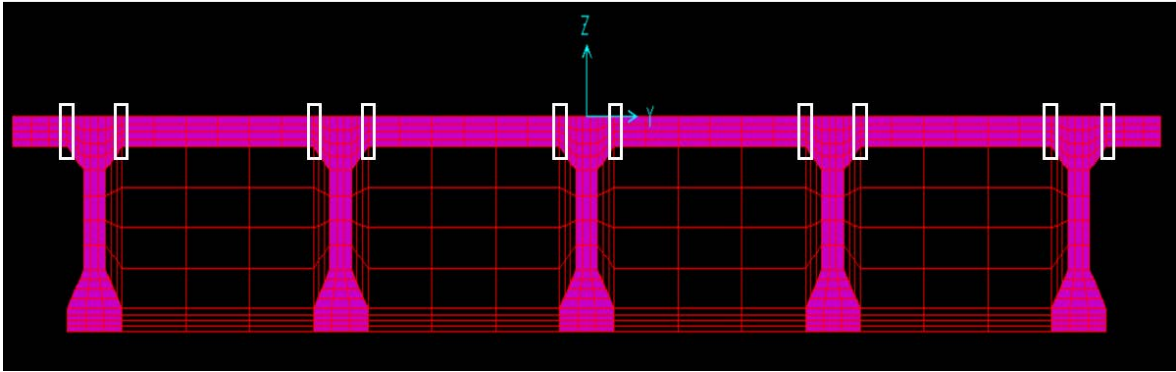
Franjas de conexión entre losa y vigas longitudinales
